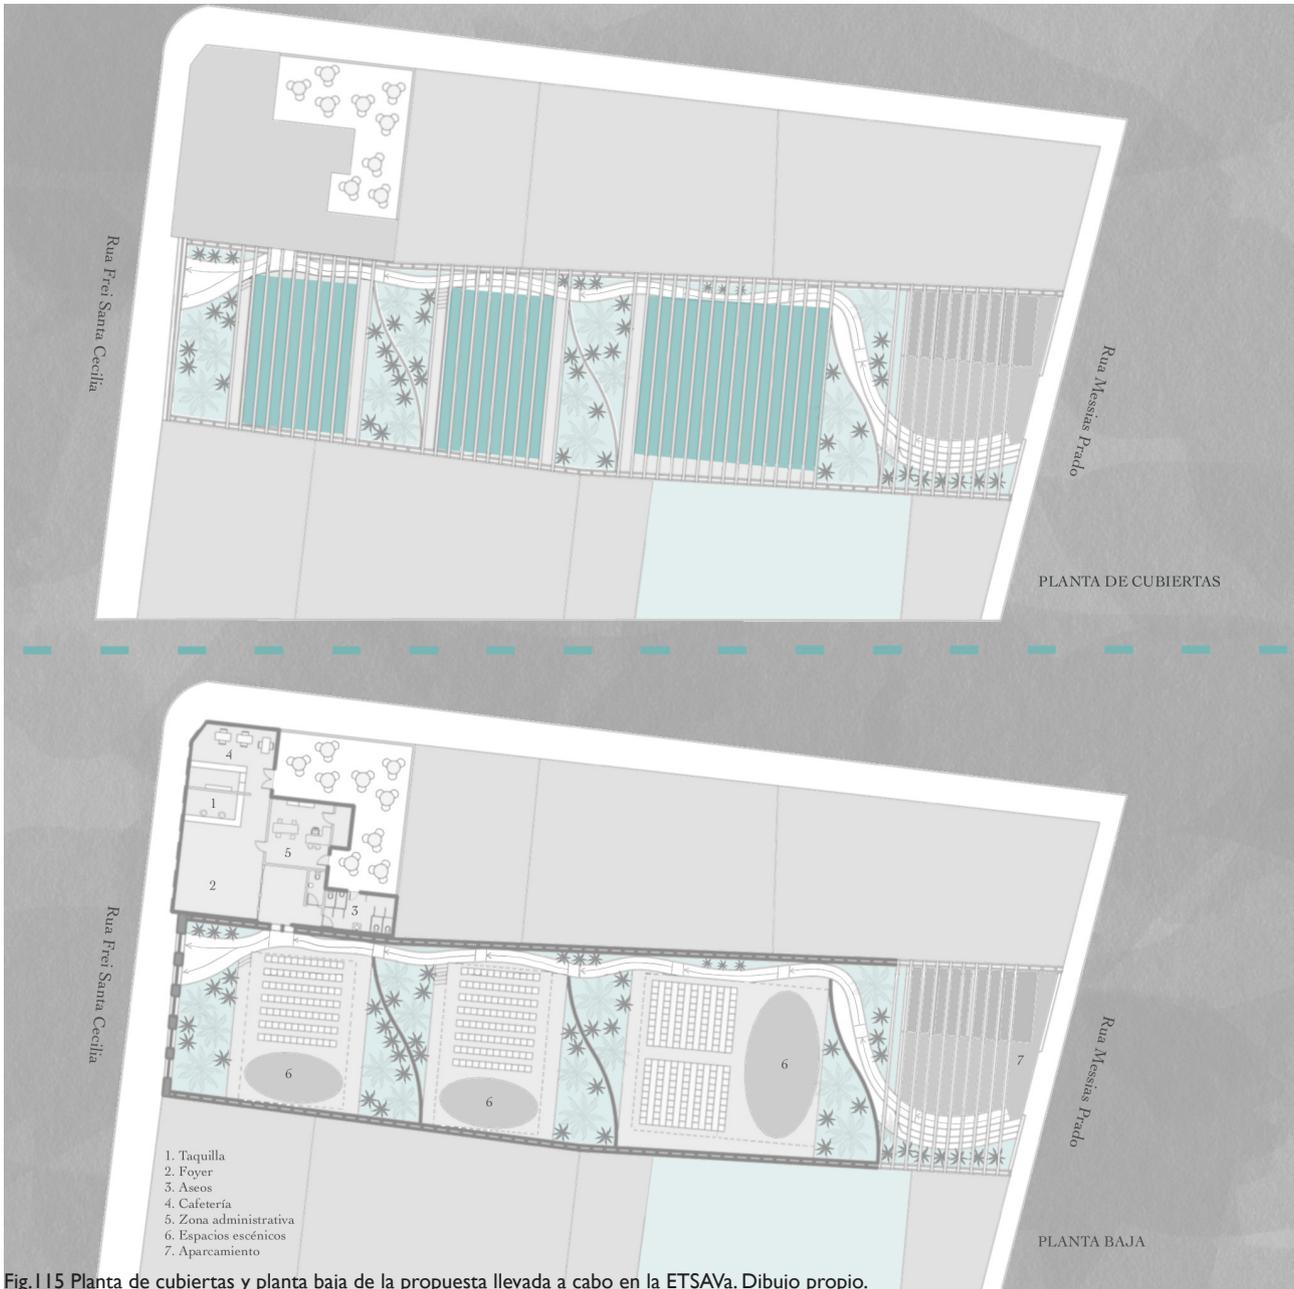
Planta de cubiertas y planta baja de la propuesta llevada a cabo en la ETSaVA. Dibujo propio.
